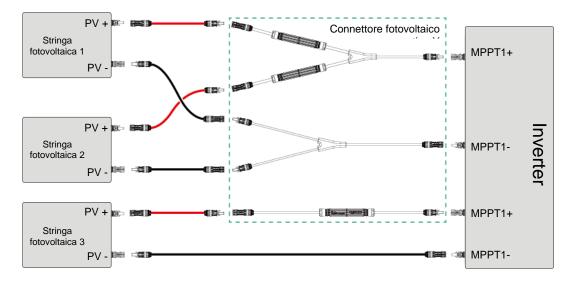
Schema di collegamento (collegamento lato inverter)
